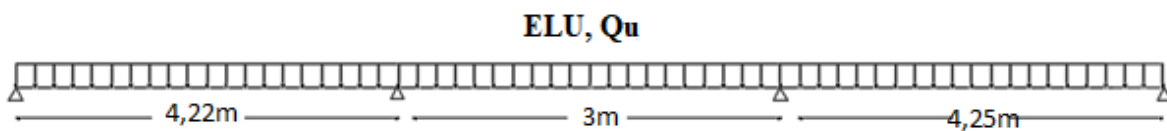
Schéma statique de la poutrelle à 3 travées.
